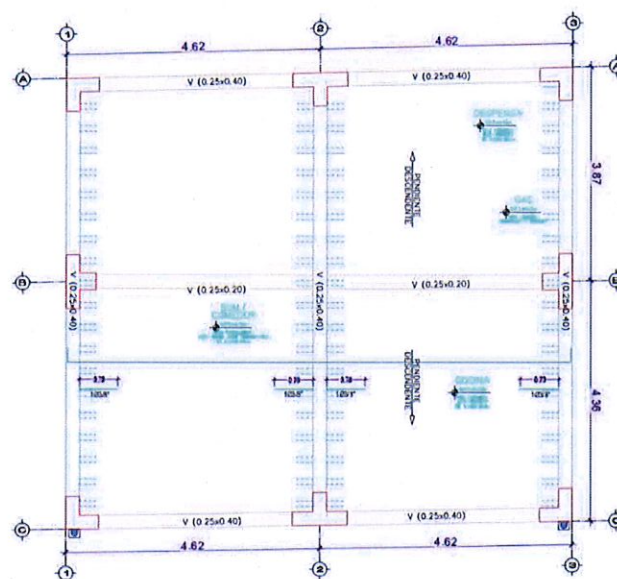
Vista en planta de la losa aligerada proyectada del Módulo I
